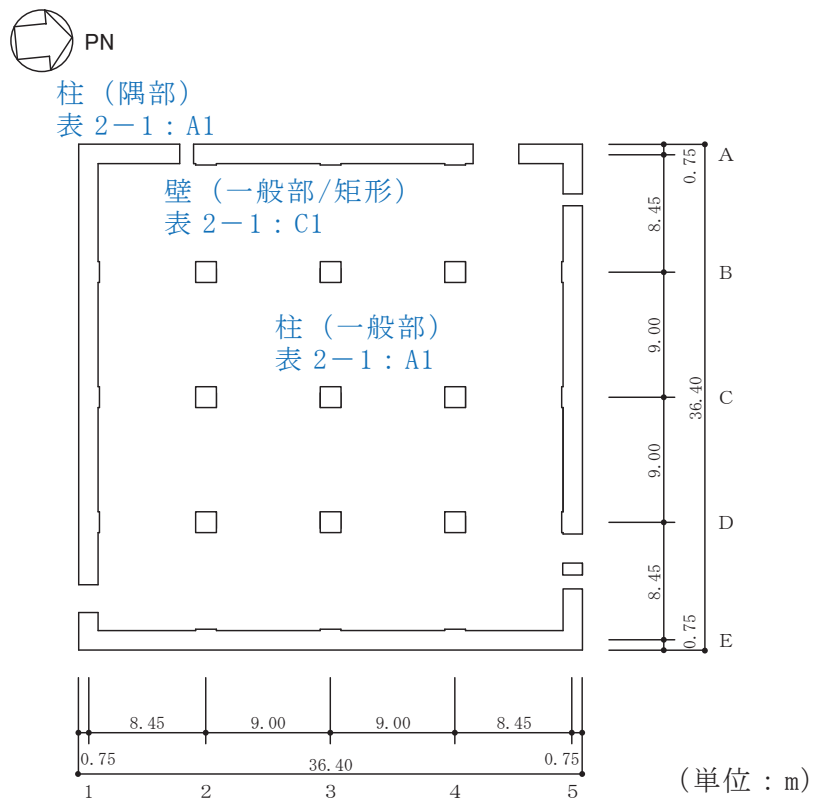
(3) 緊急時対策建屋の概略平面図 (0.P. 62. 2m)
